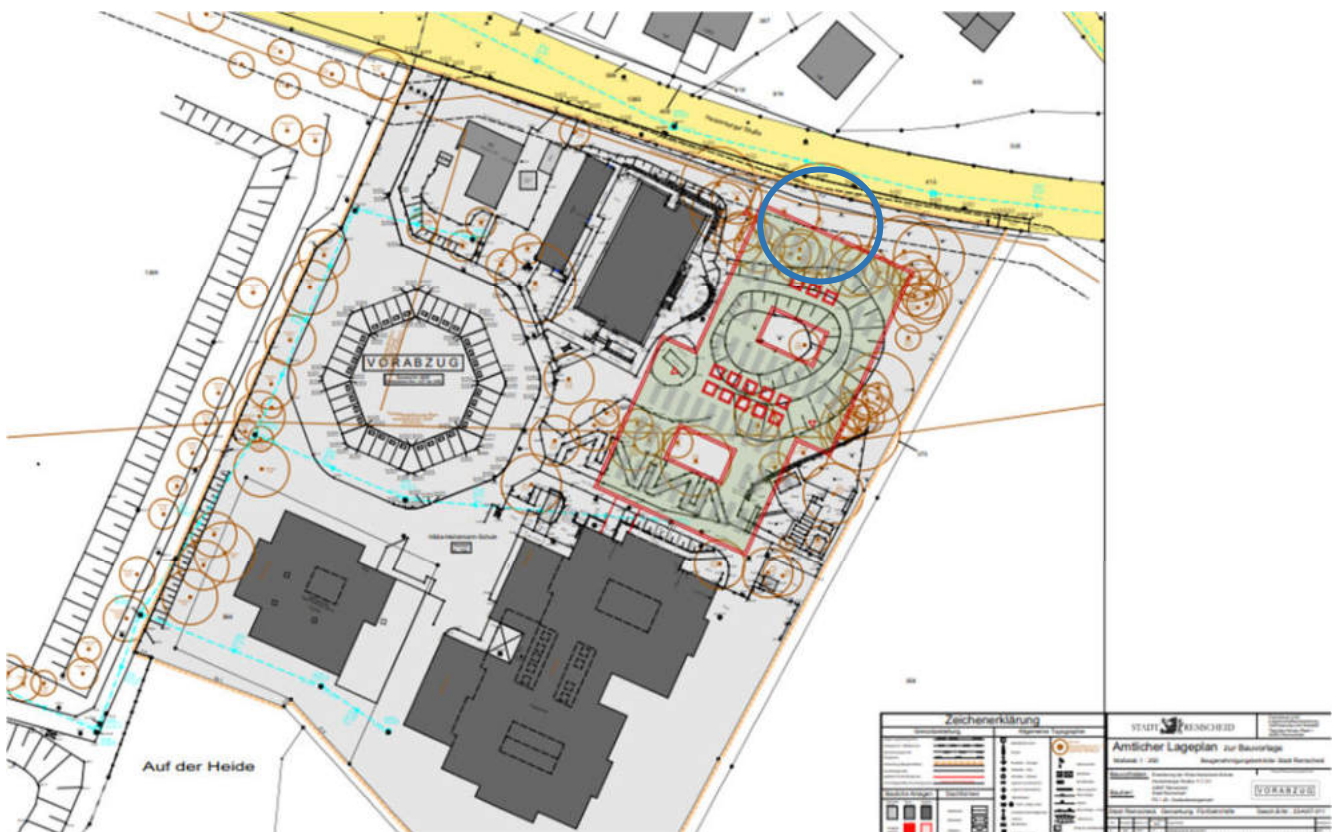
Ausschnitt amtl. Lageplan mit geplantem neuem Gebäude (rot umrandet) und Hainbuche (Kronenbereich blau umrandet) (Quelle: Stadt Remscheid, Stand 22.10.25, mit eigenen Eintragungen)
